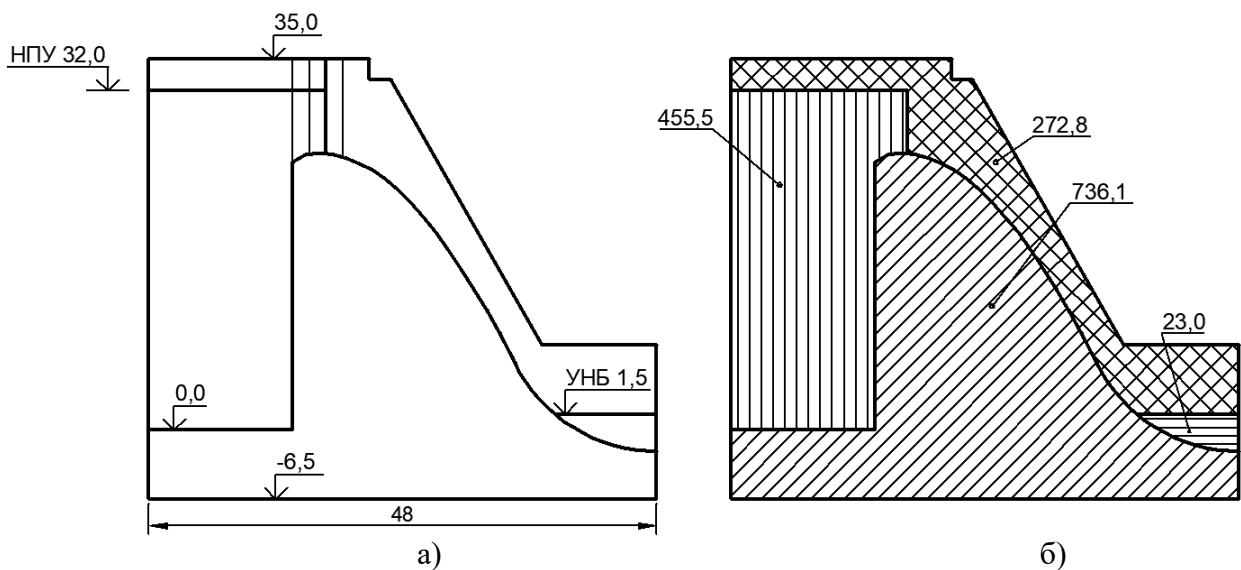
Исходные данные к расчёту нагрузок на бетонную водосливную плотину
